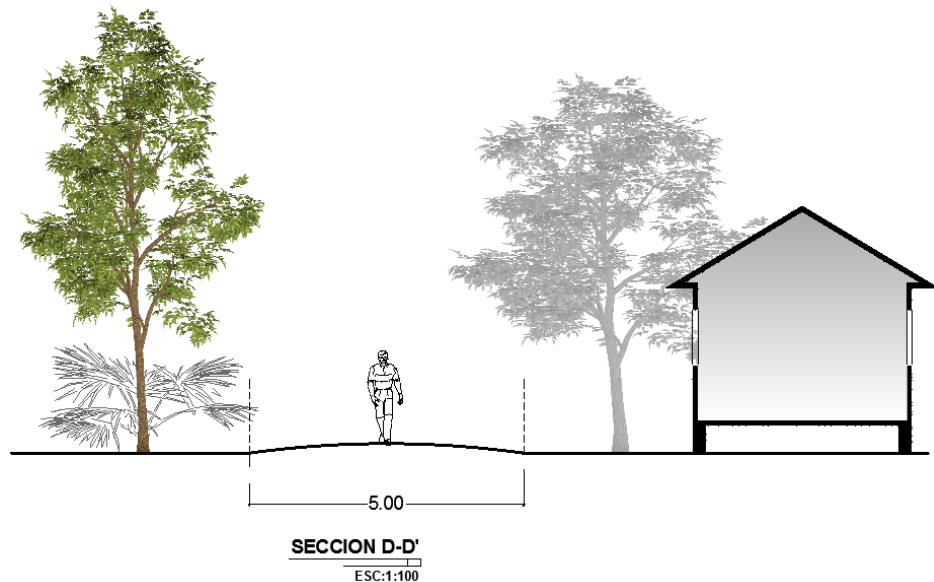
SECCION VIAL DEL BARRIO PALMERAS SECTOR LAS LOMAS.
